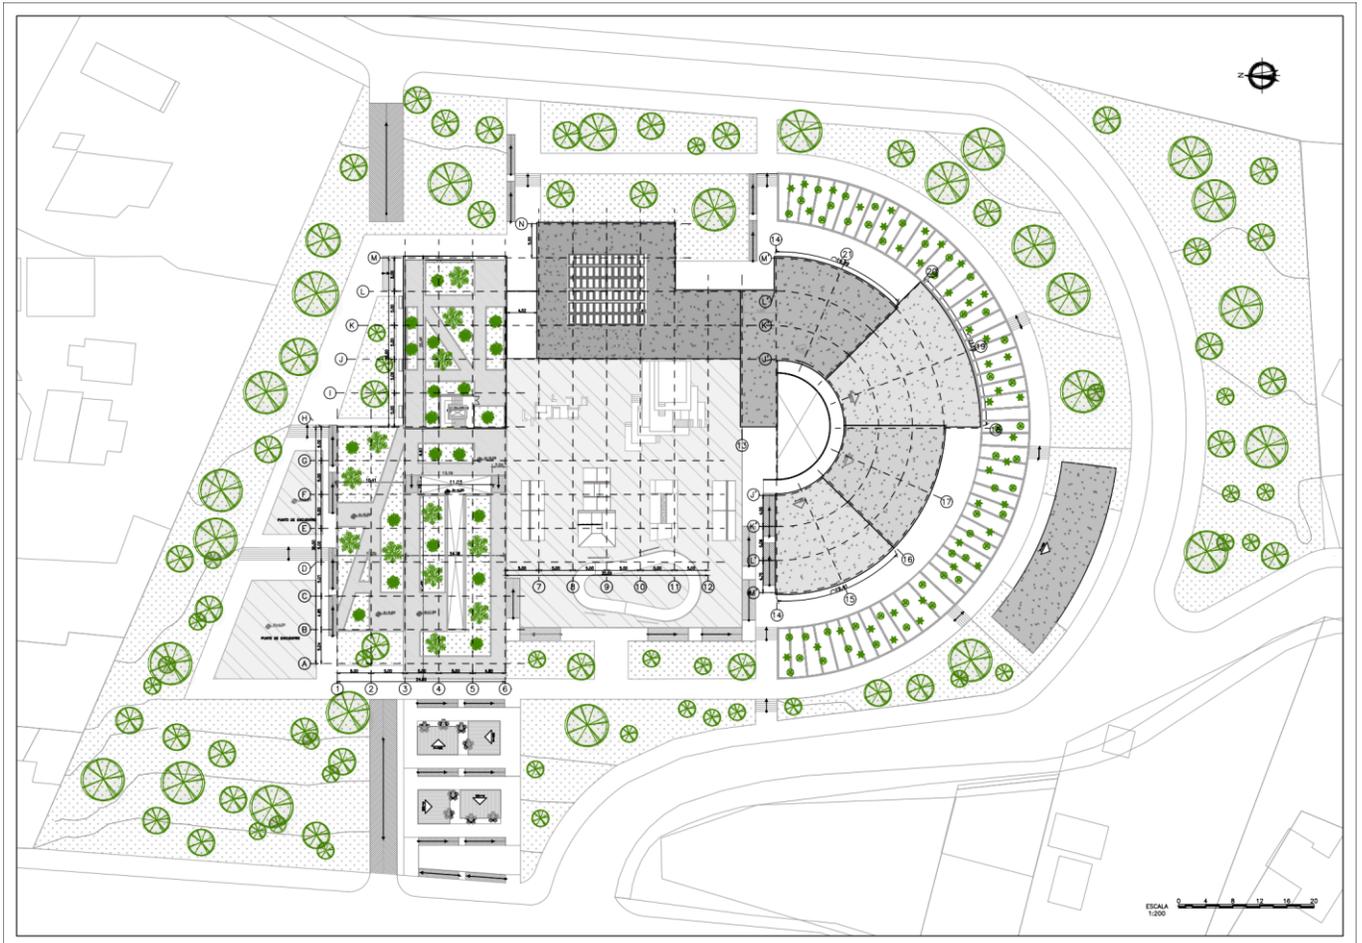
Desarrollo arquitectónico planta cubiertas. Fuente: Elaboración propia.
